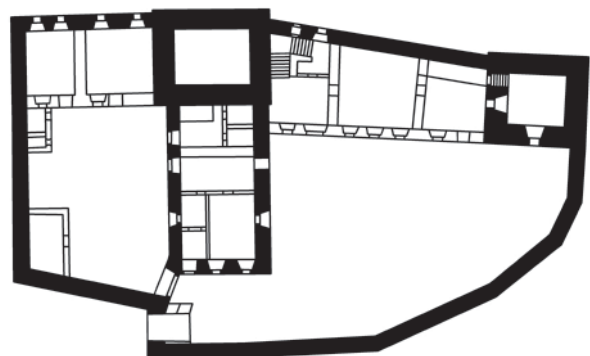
Lageplan des Pflegersitzes Fischhorn mit Kernburg und Pflgerturm (Autor: P. Schicht).
